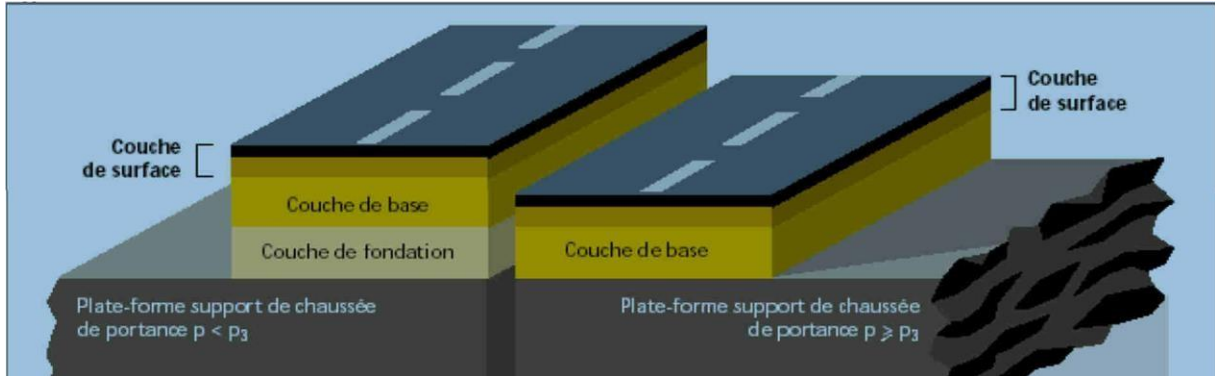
9. Structure type : Structure type d'une chaussée semi-rigide (jafijaf, 2015, p. 12)
